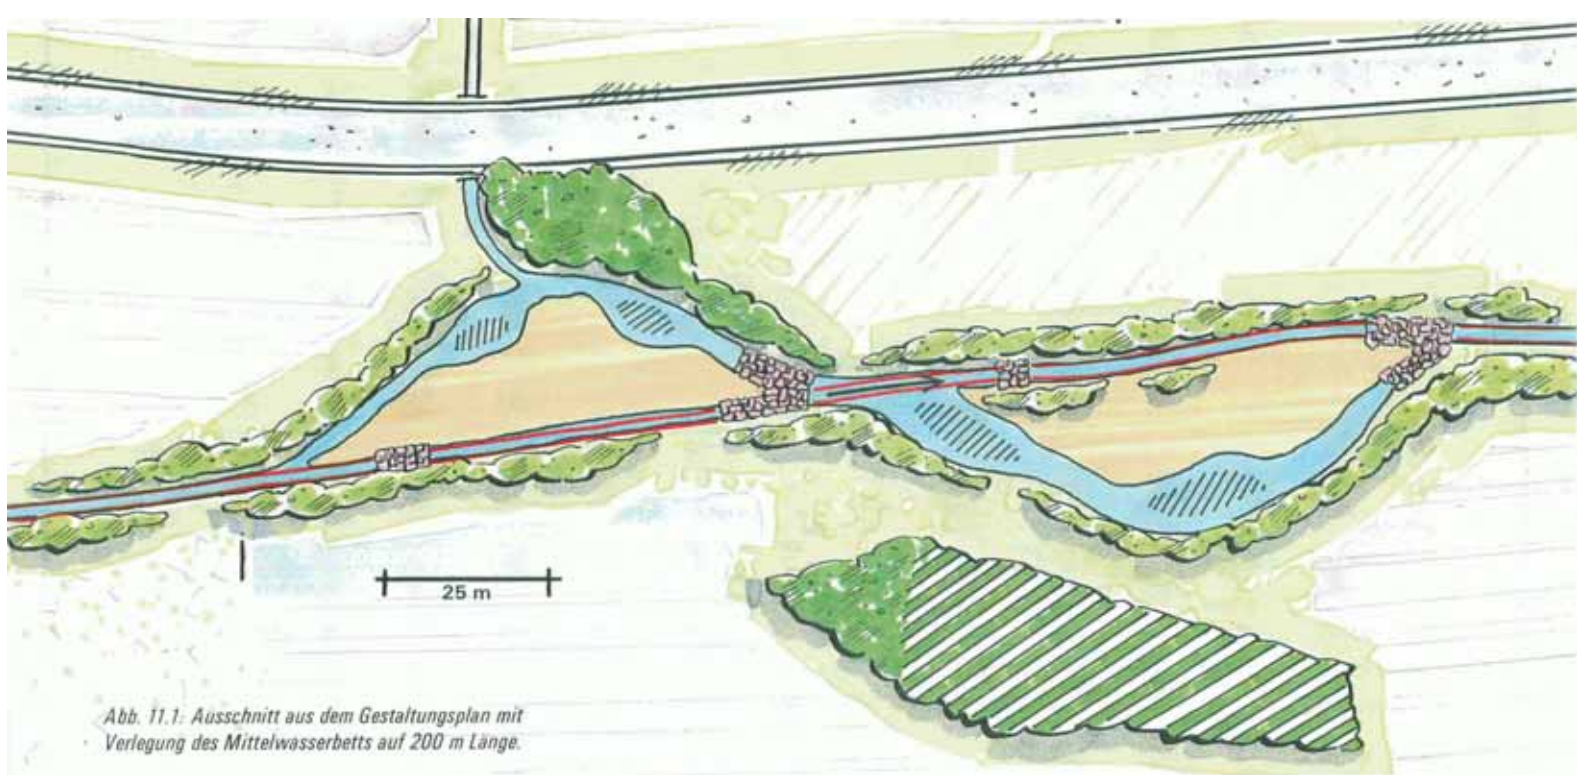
Ausschnitt aus dem Gestaltungsplan mit Verlegung des Mittelwasserbetts auf 200 m Länge.
